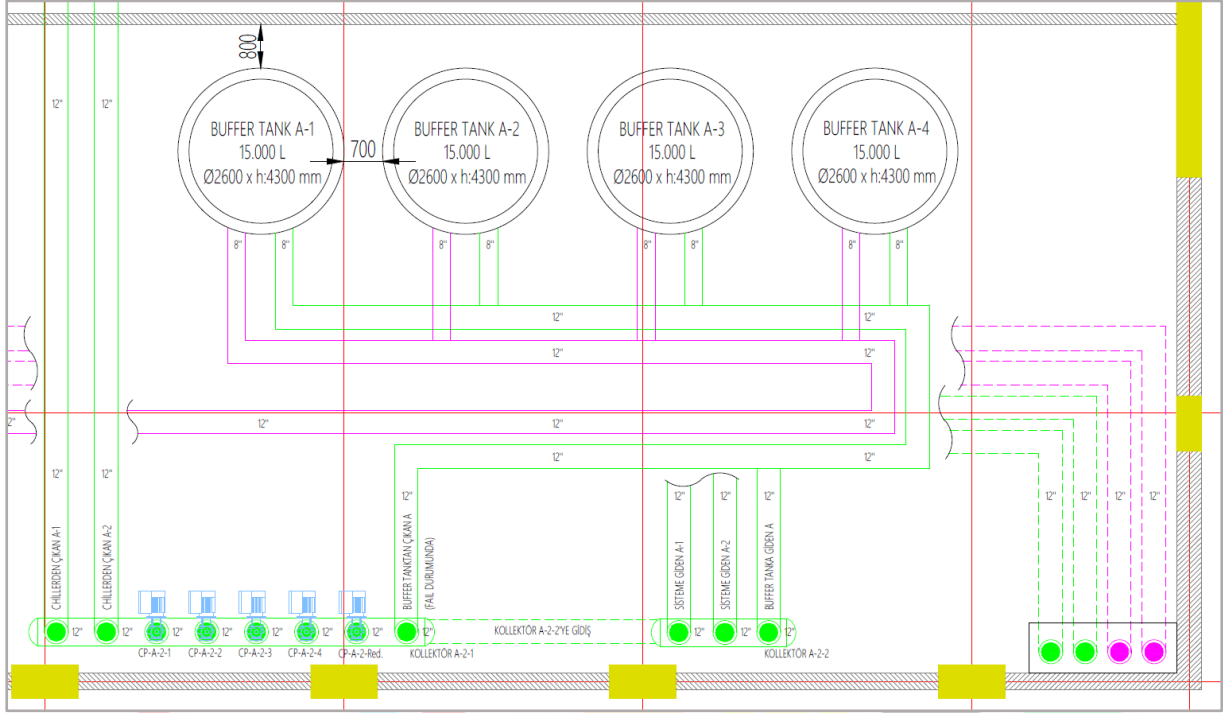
Hava Soğutmalı Veri Merkezinin Çatı Planı Tasarımı Detay-3
